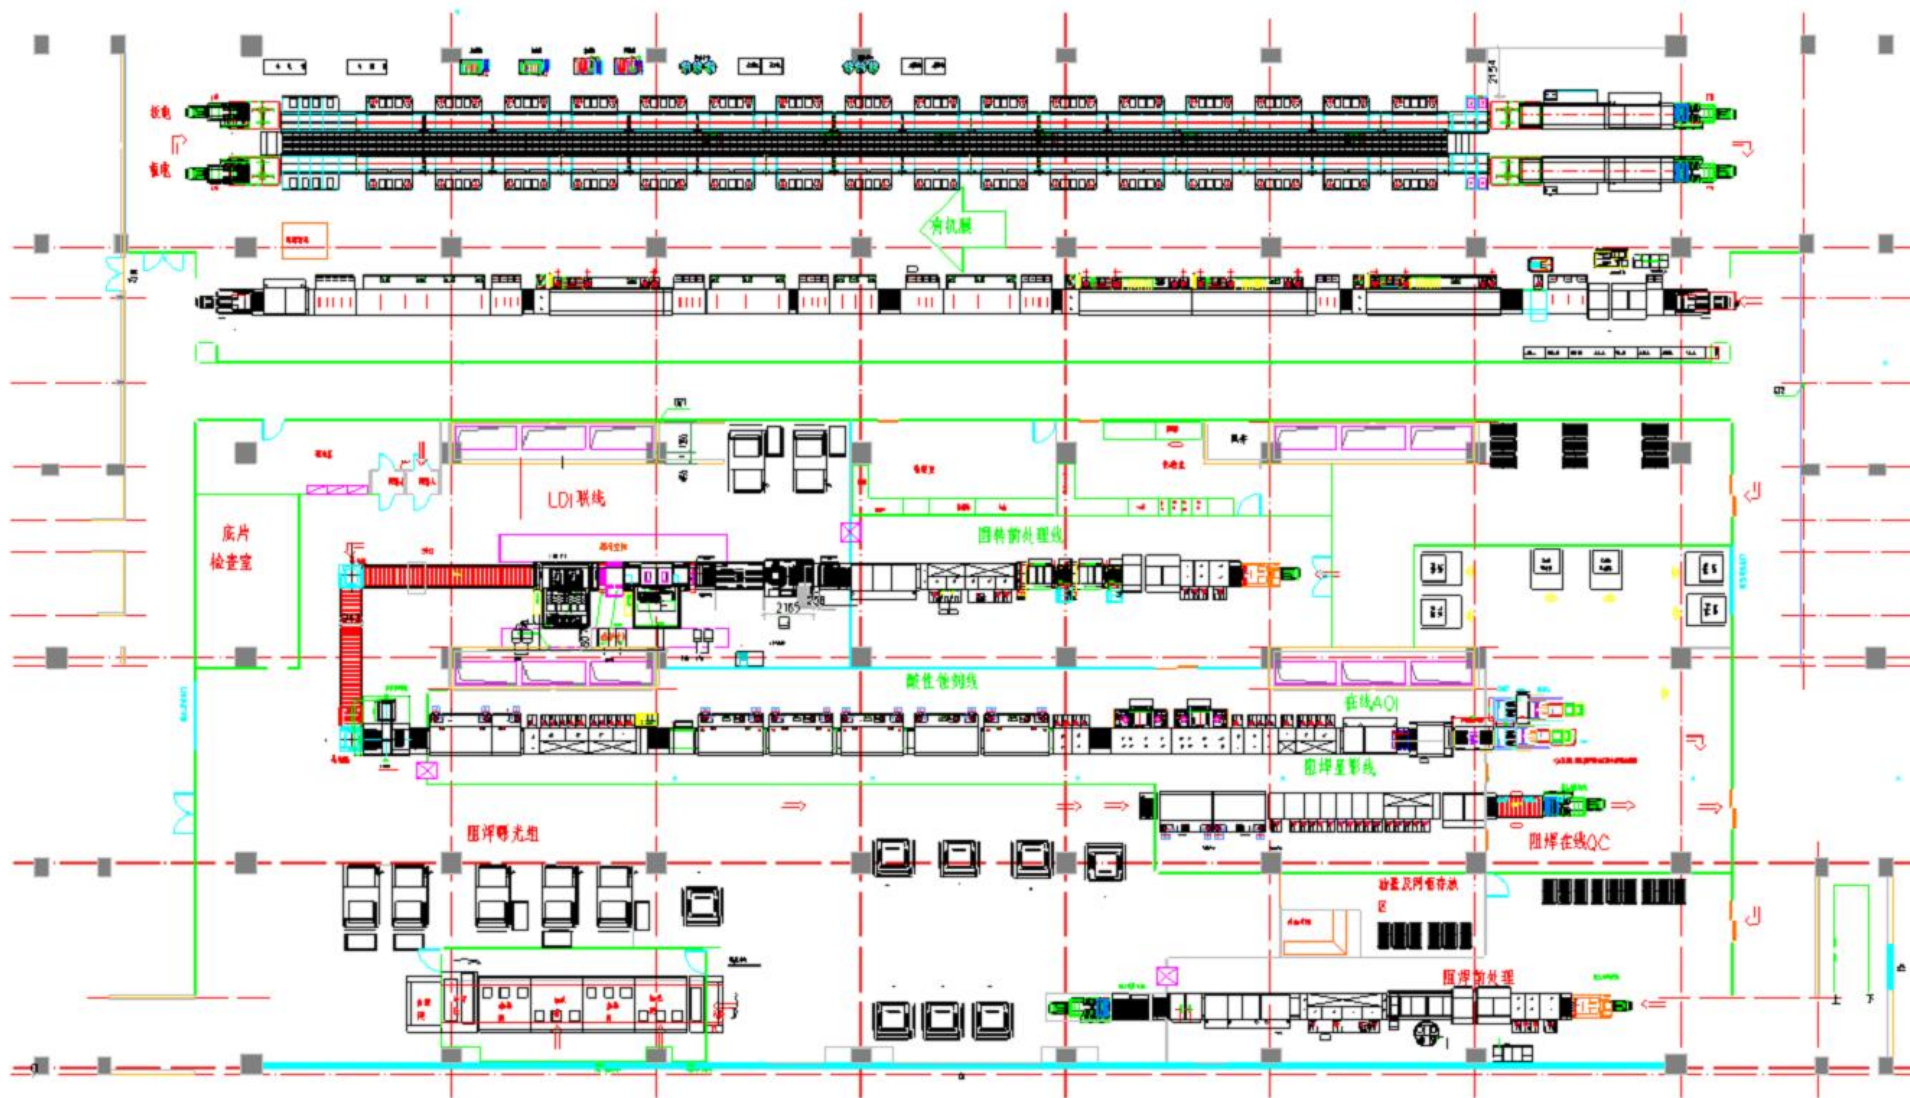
本项目二号厂房 3 楼实际平面布置图
